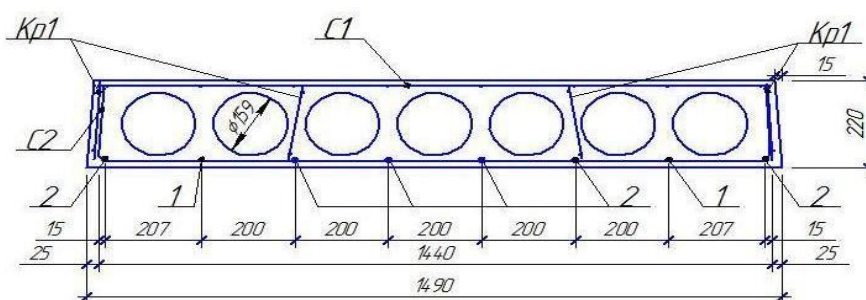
План-схема конструкции сборной железобетонной плиты покрытия малоэтажного дома
